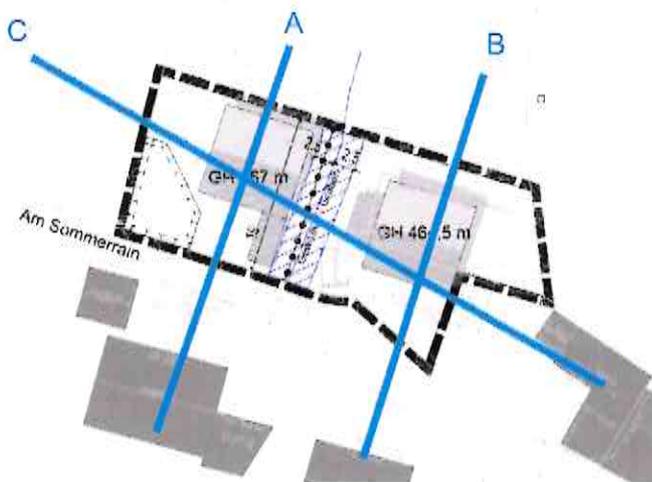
Lageplan einer möglichen Bebauung mit den Schnittlinien für die folgenden Schnitte
